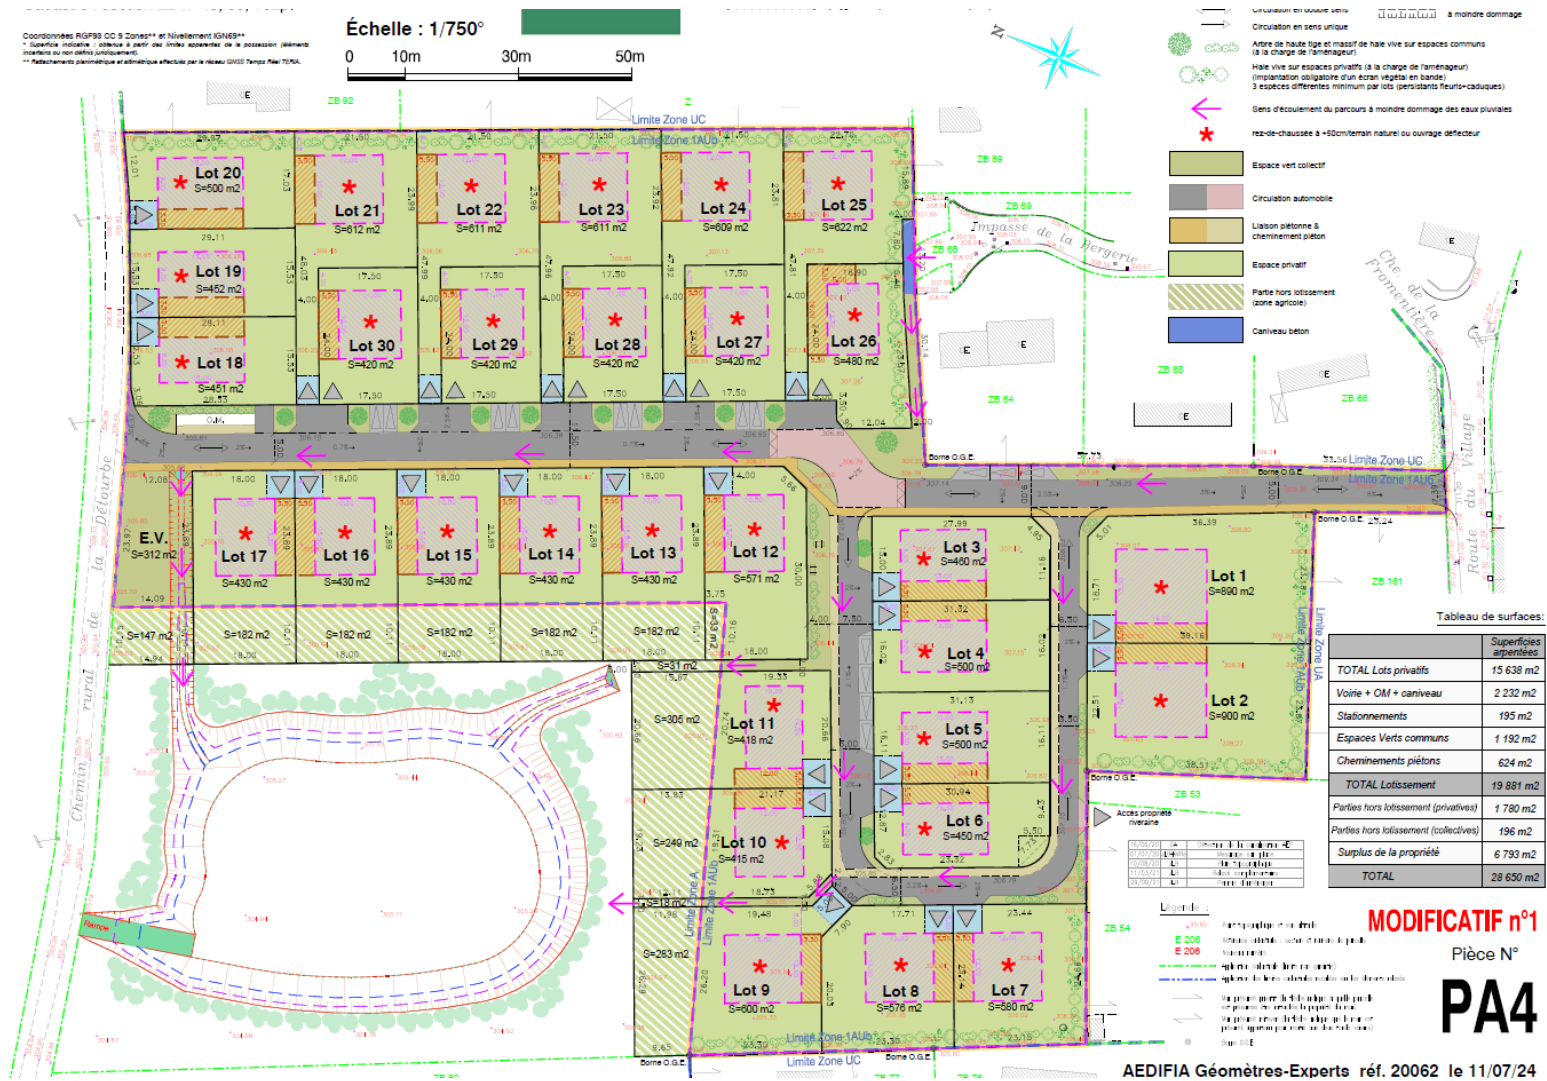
Plan masse de lotissement (Source : AEDIFIA, 07/2024)
